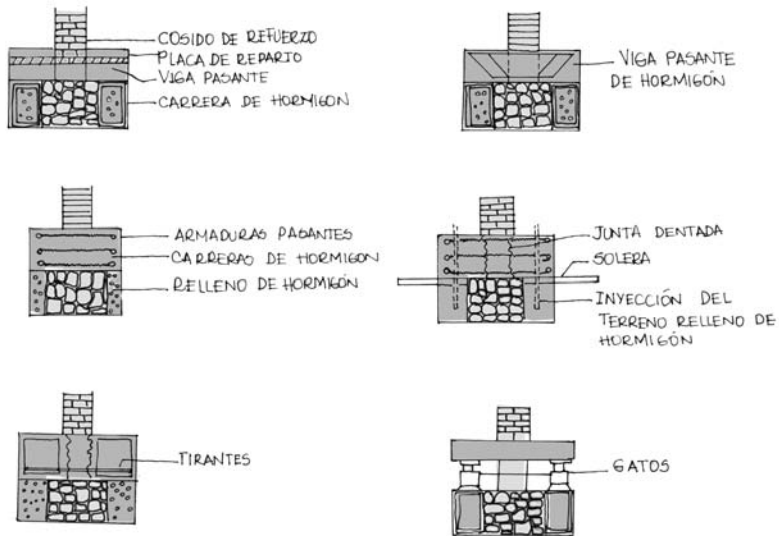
Soluciones de puenteo de la carga para el ensanche de zapatas corridas
